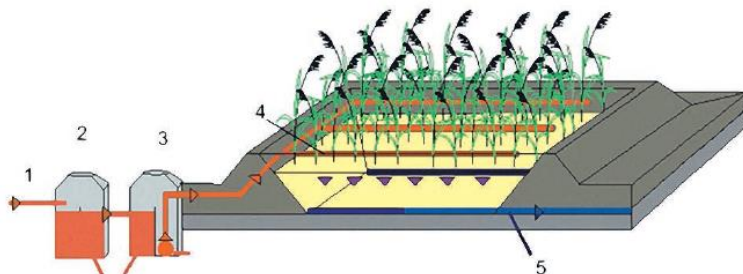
Схема грунтово-растительной площадки с вертикальным
